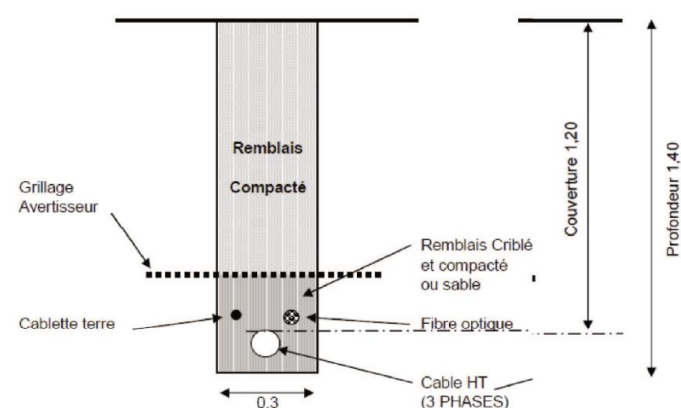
Coupe type d'une tranchée accueillant le câblage (Source : BE Jacquel et Chatillon)
